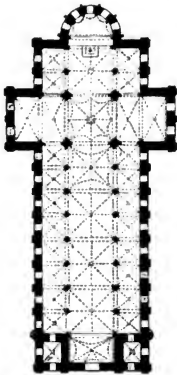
Grundriss der Kirche Ste. Trinité zu Caen. (Nach Ouden.)
